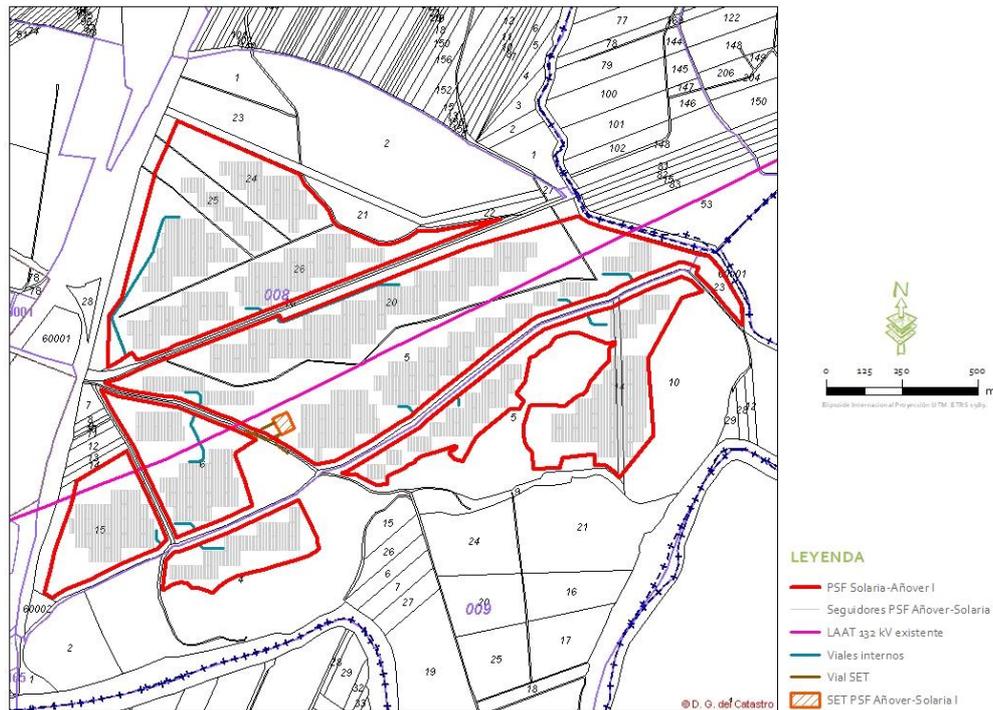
b. Parcelas catastrales afectadas en la construcción de la PSF. Fuente: Proyecto PSF SOLARIA-AÑOVER I.
